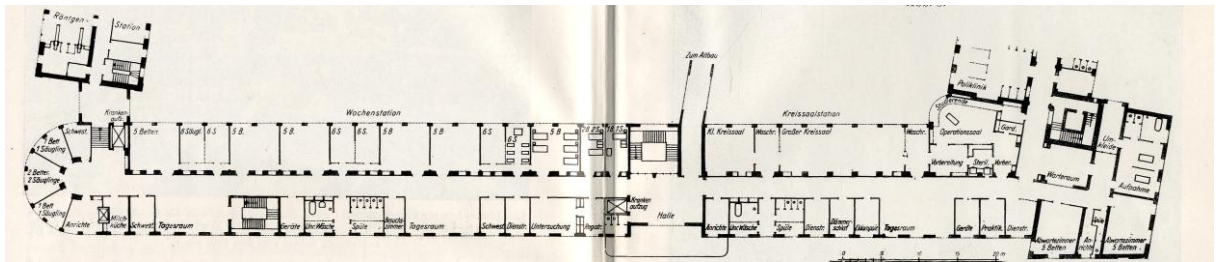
Grundriss erstes Obergeschoss Z-Bau (Stoeckel 1932 S. 672 f)
